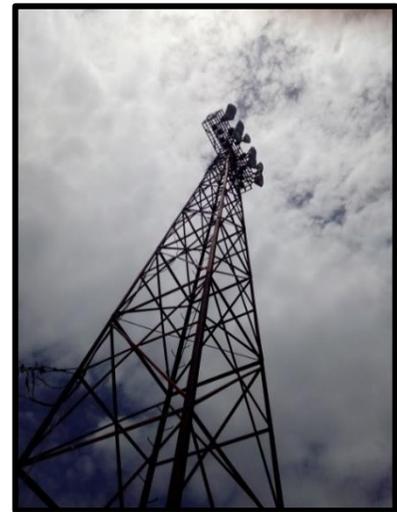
La mayoría de las luminarias están en buen estado, la estructura de las torres en mal estado.
